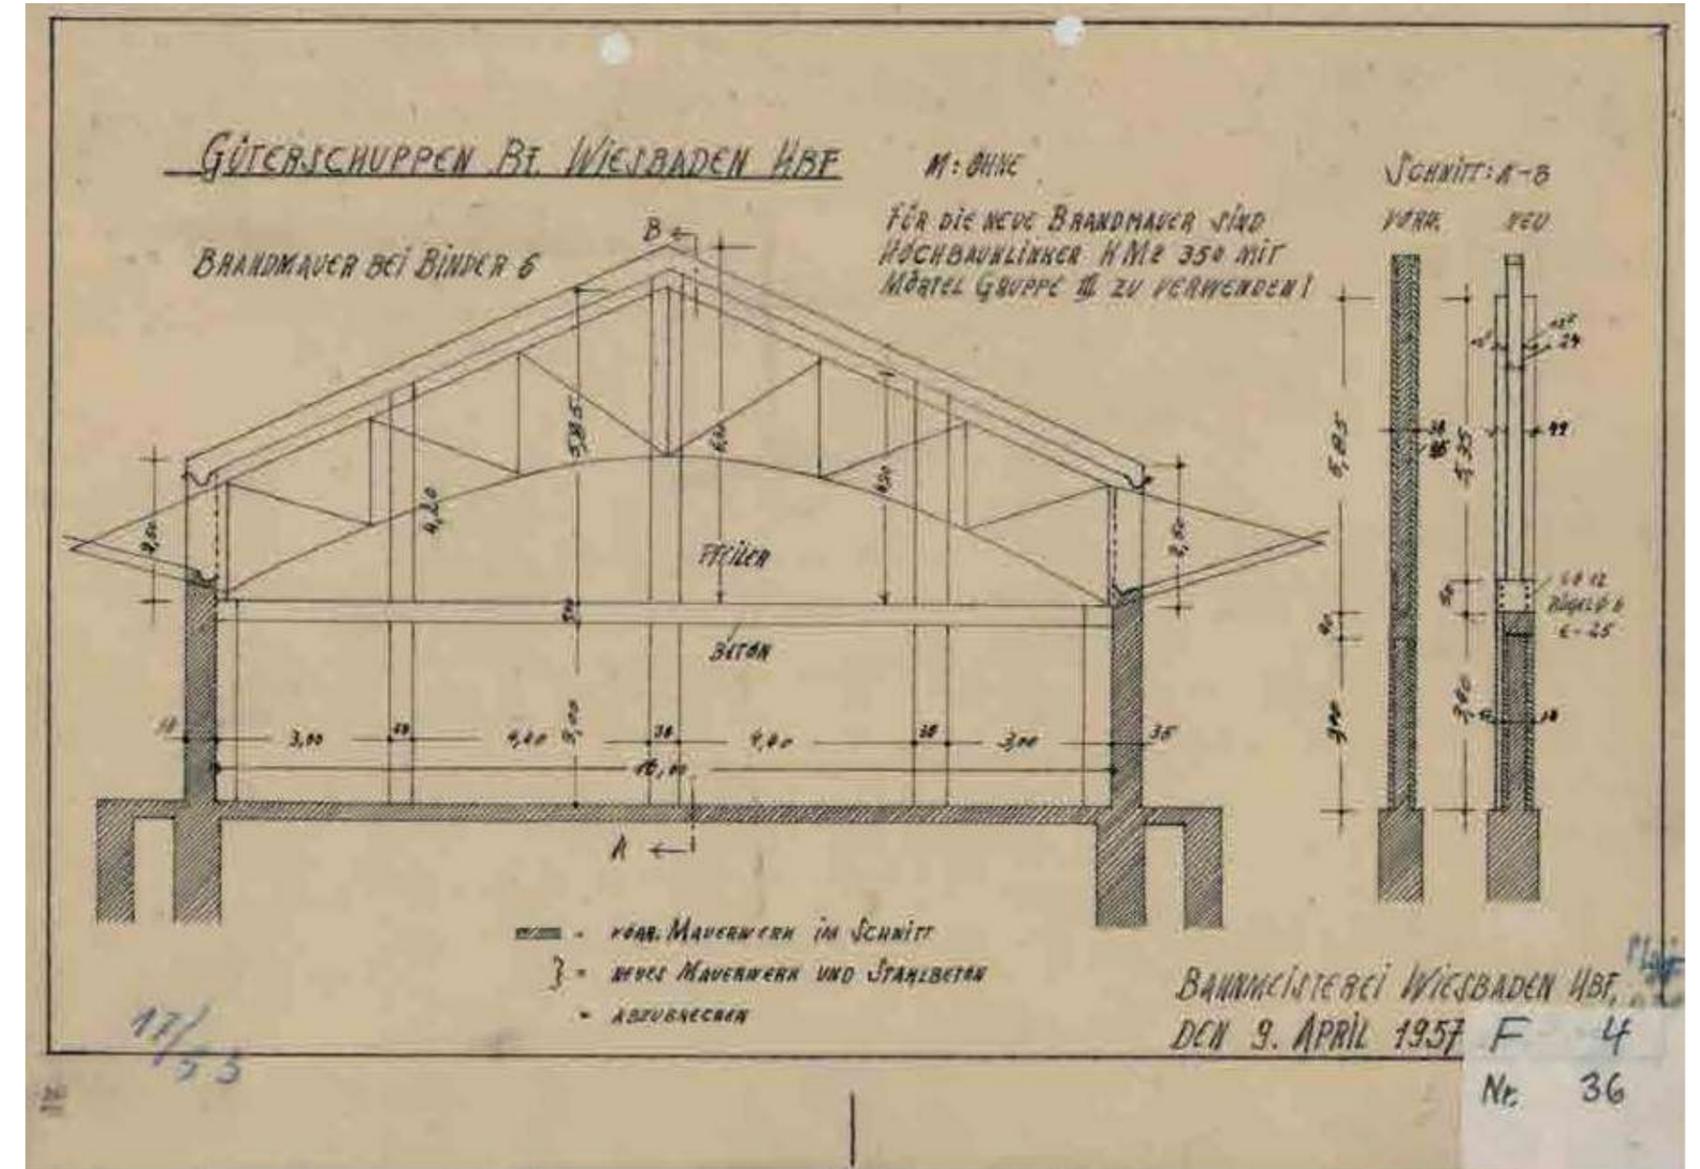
Stückgutschuppen: Plan für die Errichtung neuer Brandmauern aus Hochbauklinker und Beton, 1957
